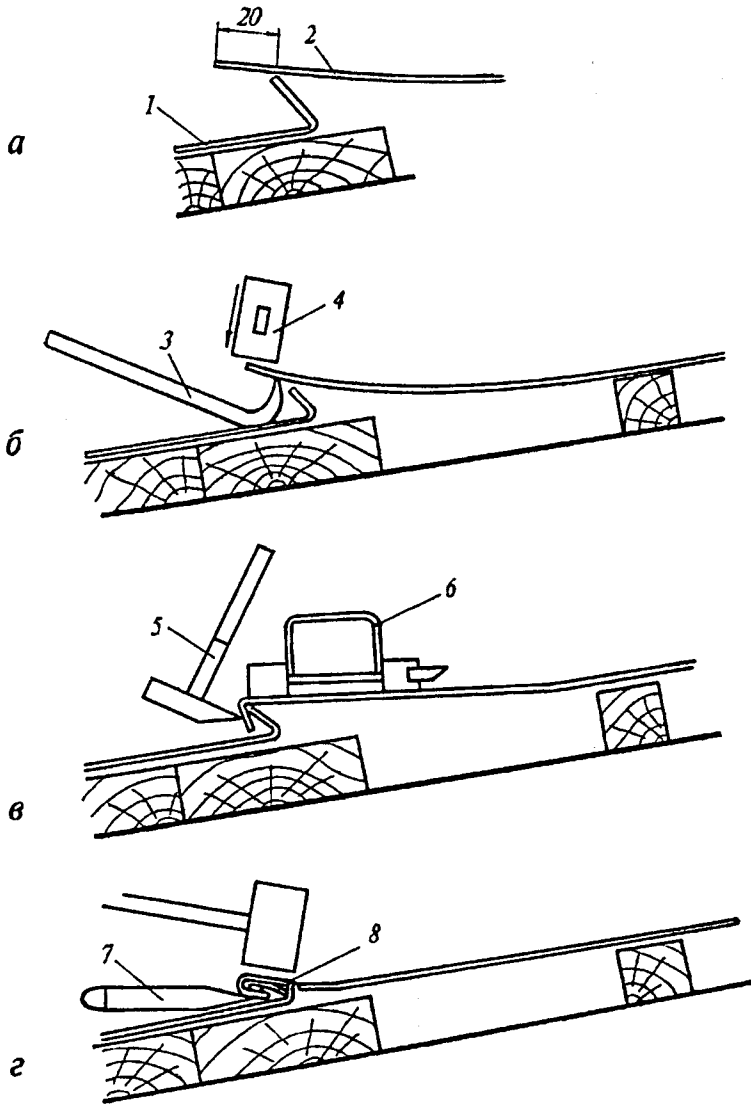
1 – надстінний жолоб; 2 – край покриття рядами; 3 – металева лапа; 4 – киянка; 5 – молоток-підскальник; 6 – гребнезгин; 7 – зубило; 8 – фальцеве з'єднання
